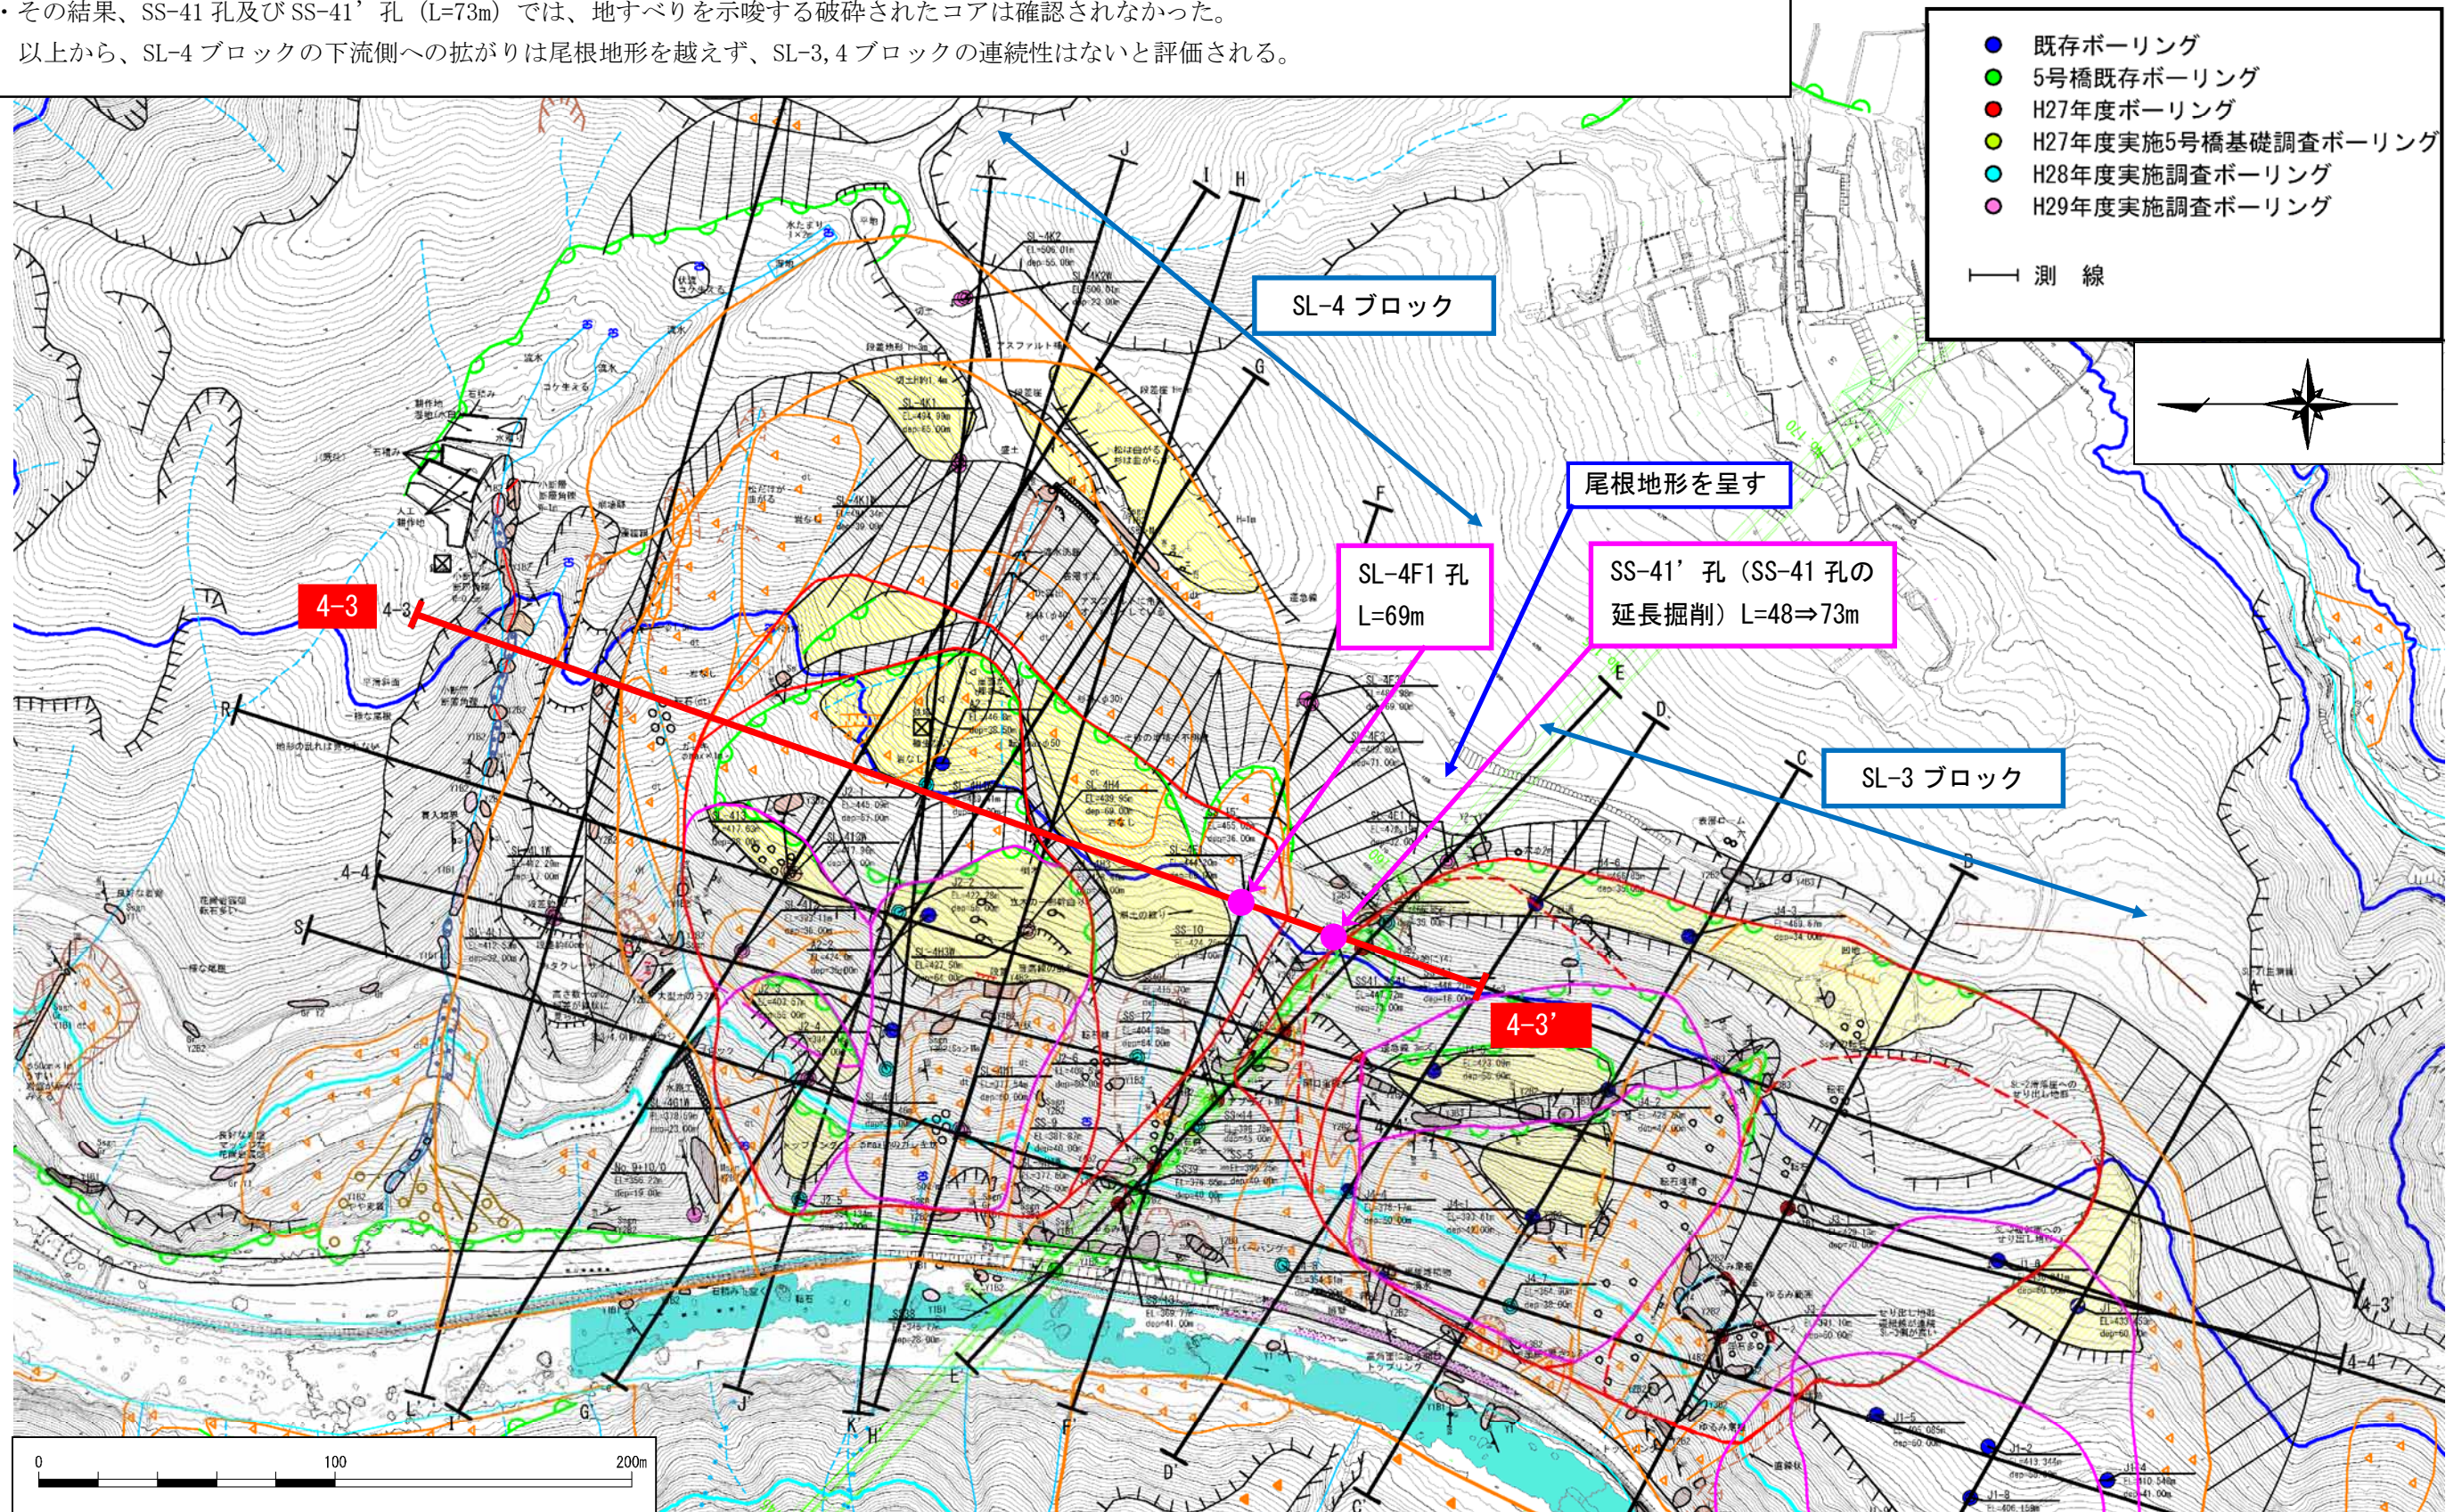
SL-3、4ブロックの連続性の検討 調査位置平面図
